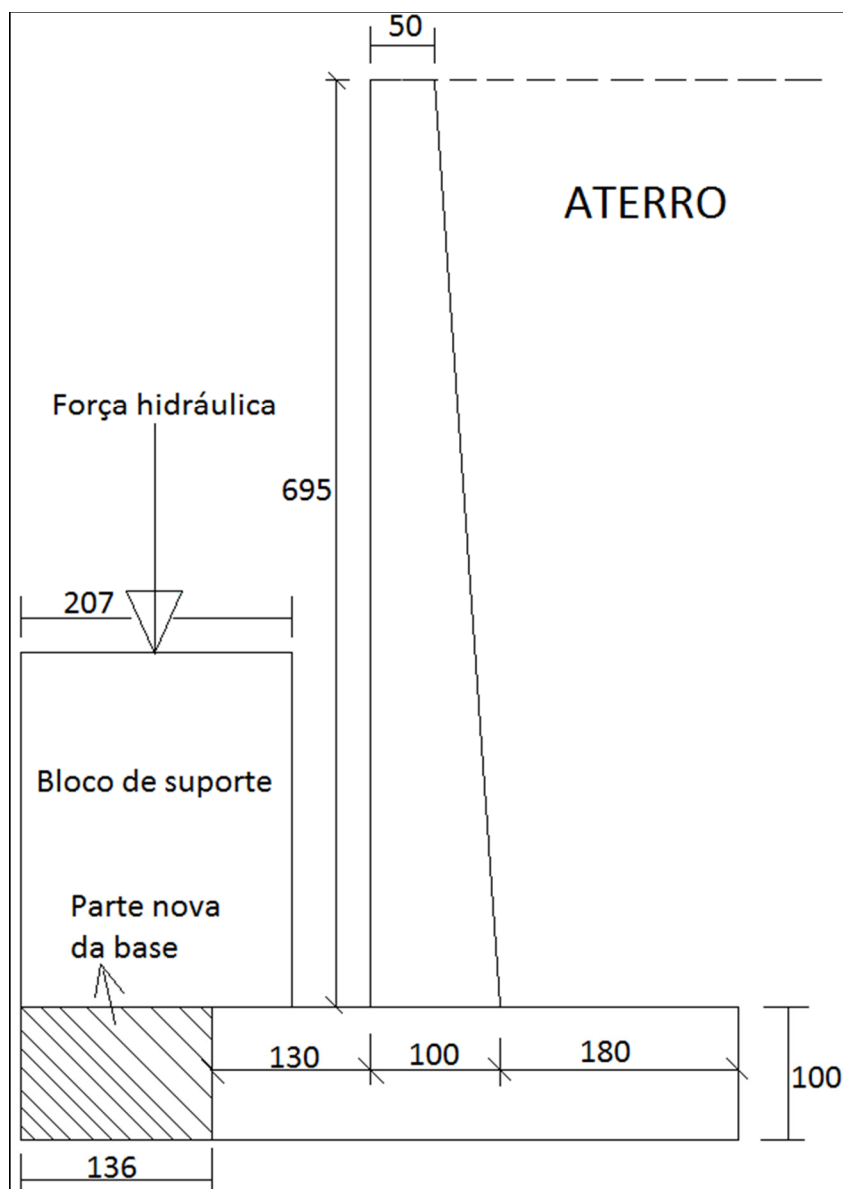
Muro de arrimo com adição da nova base (nova proposta)
